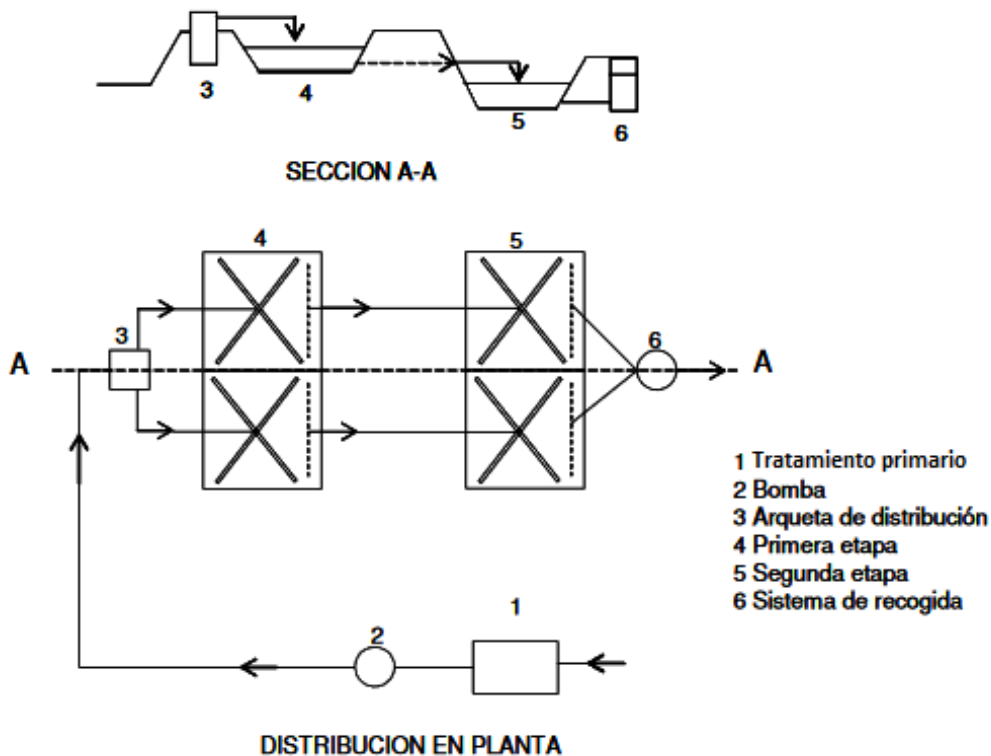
Perfil y planta de la disposición de las celdas del humedal. Fuente: IWA
